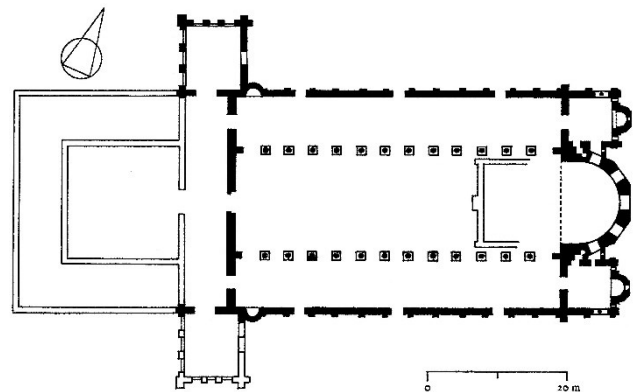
Grundriss von Sant' Apollinare in Classe in Ravenna
